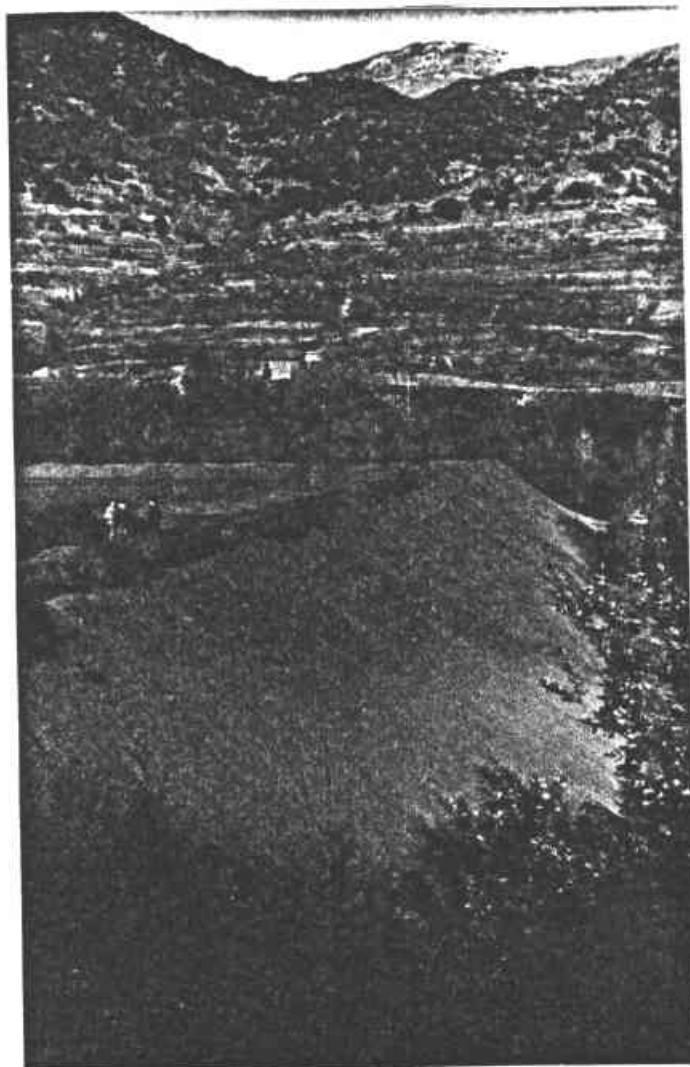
Digue transversale du bassin n° 4 : parement aval
